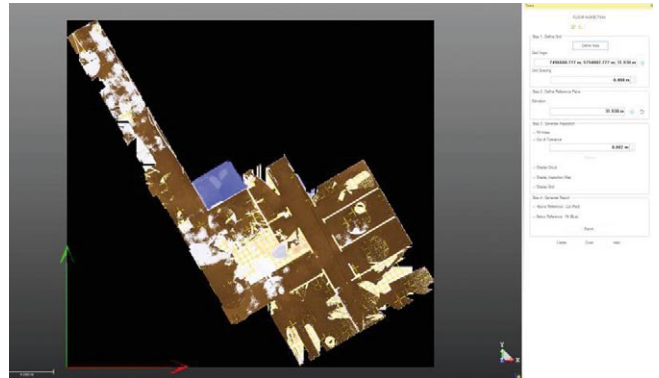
Przykład 2 – chmura punktów z podziałem na elementy konstrukcyjne – poziom +3 (opracowanie własne)
